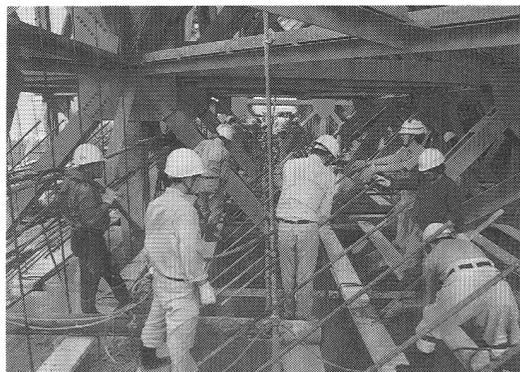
アンカーフレーム内のコンクリート打設状況 (7A)
